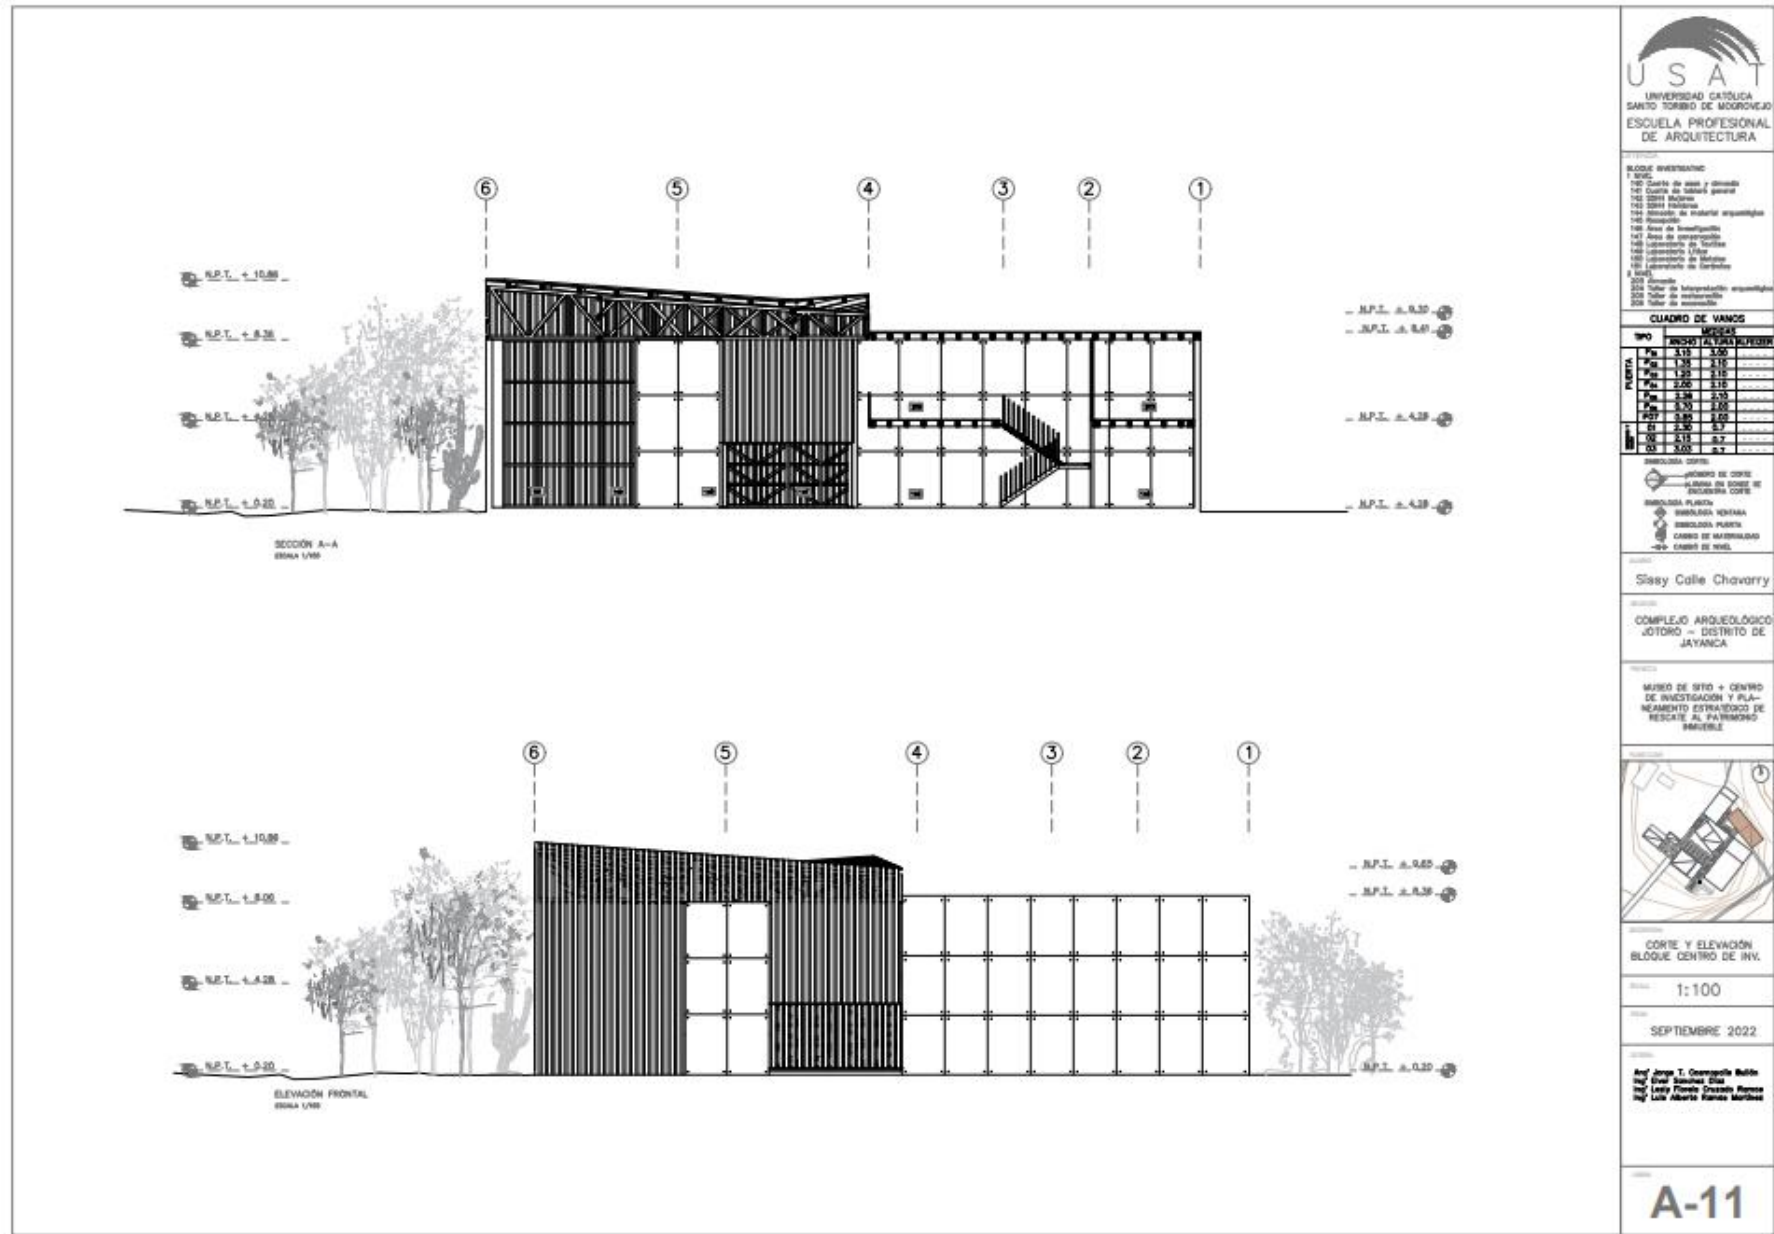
Planos de detalle bloque centro de investigación y planeamiento estratégico de rescate al patrimonio inmueble. Fuente: Propia
